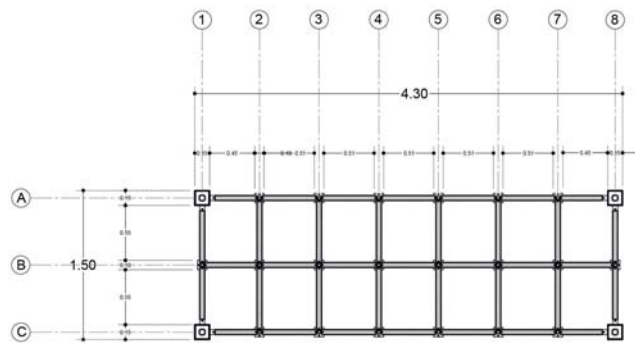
Nelly Hernandez (2018) Criterio estructural (plano).
